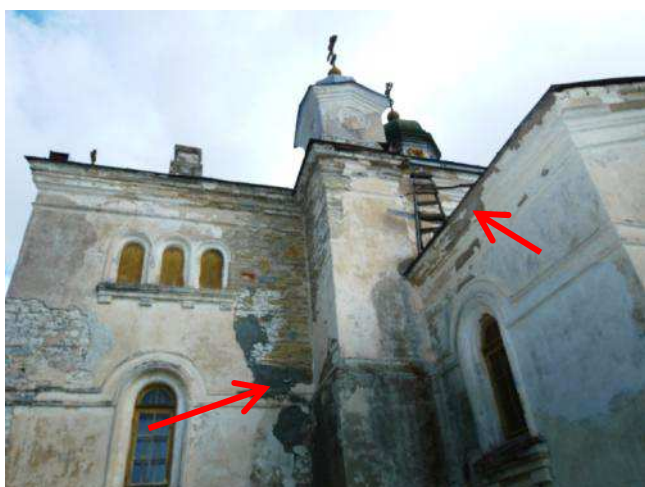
Tsementmördiga parandatud kahjustatud krohv
